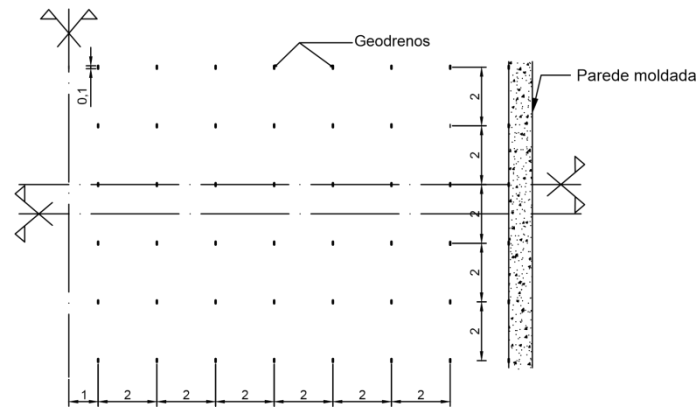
Representação esquemática da distribuição dos drenos verticais em planta
